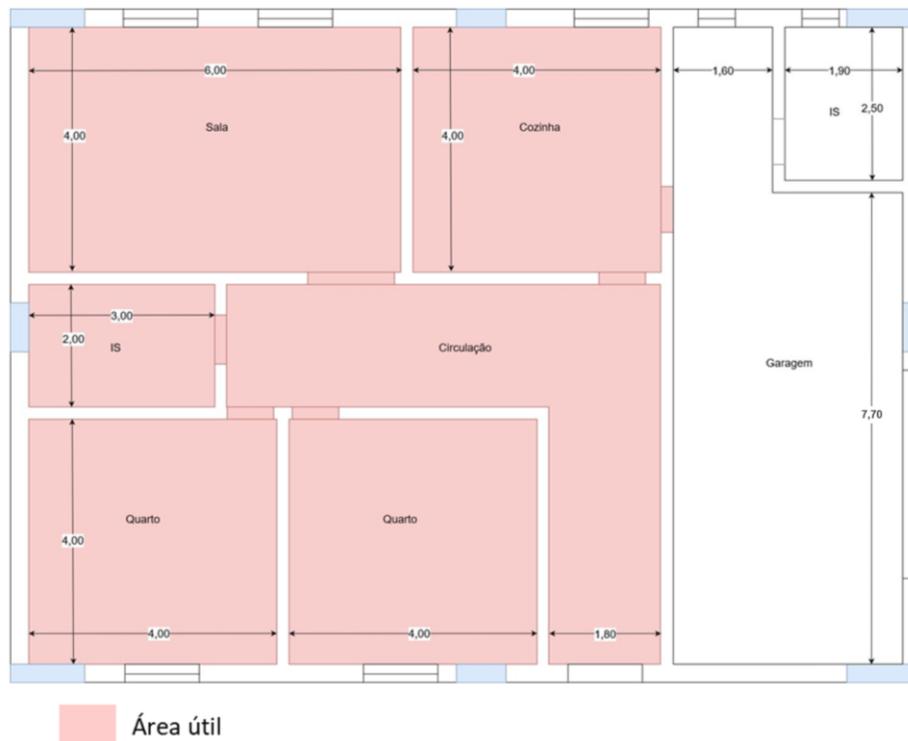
Exemplo: Marcação da área interior útil de pavimento.
